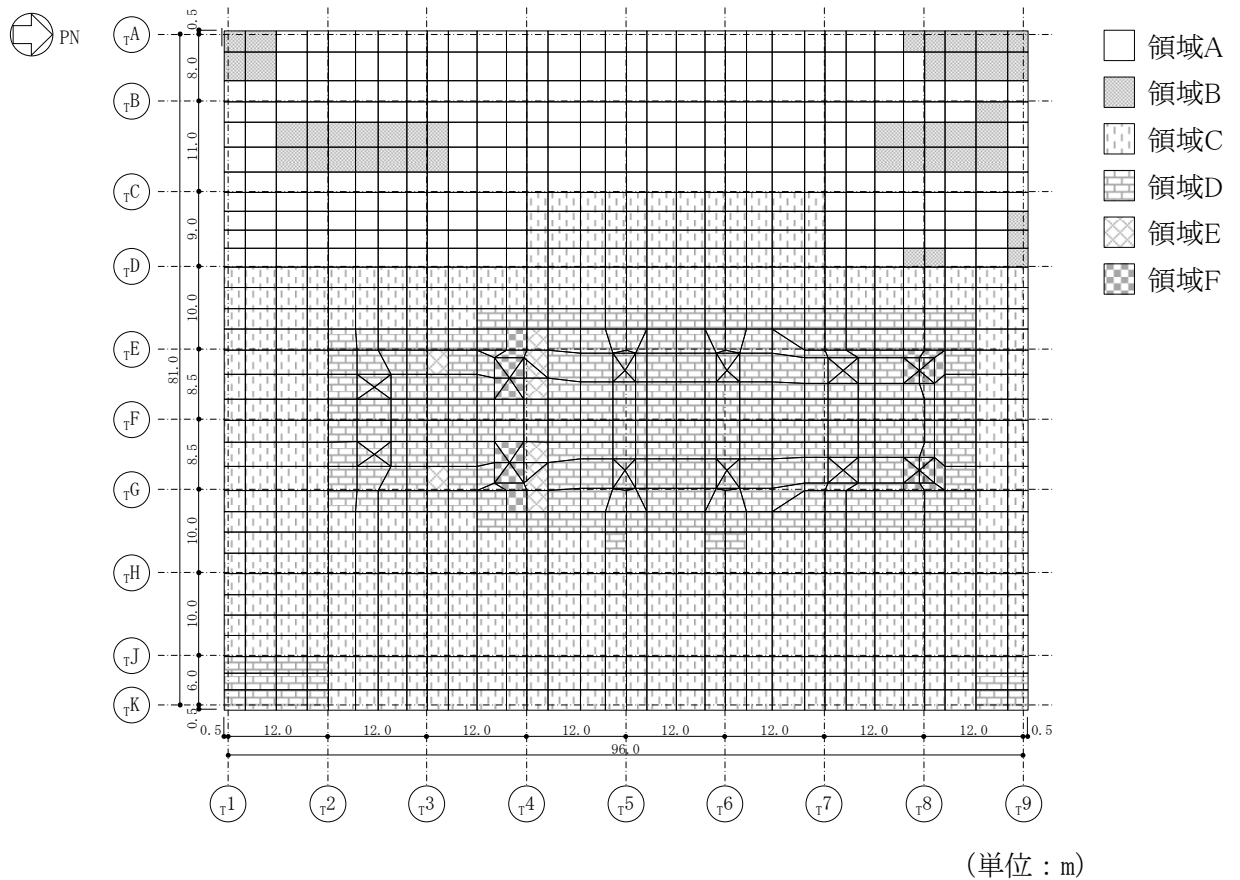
基礎スラブの配筋領域図 (EW 方向, 上ば筋)
